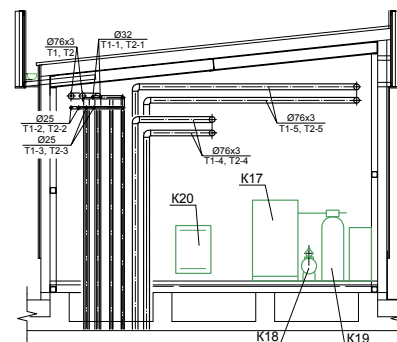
Распределение нагрузок по контурам: отопление, вентиляция, горячие водоснабжение
